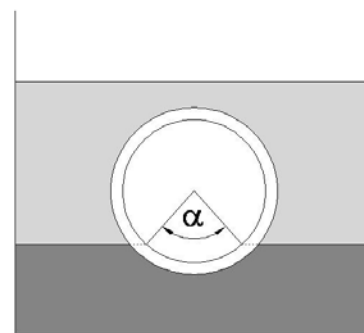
1 Ángulo del perímetro interior soportado de la tubería
